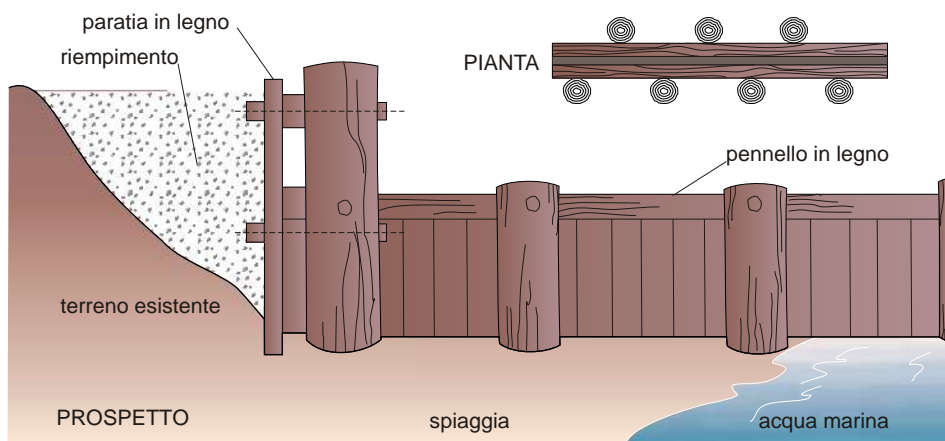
Pennello impermeabile con tavole e pali in legno trattati. Questo tipo di struttura è indicato per paraggi non soggetti a forte ondatazione e necessita di una buona infissione degli elementi nella sabbia e di un buon trattamento impermeabilizzante per il legname.
